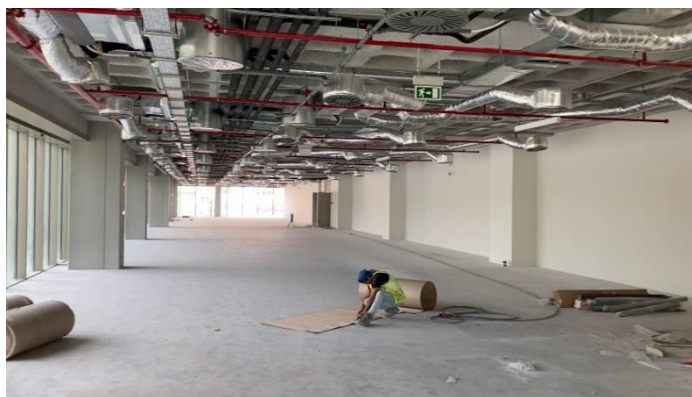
Interior de uma fração já com o pavimento falso e com a instalação em tetos concluída.
